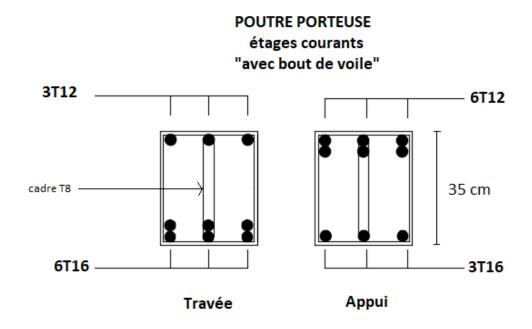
ferraillage des poutres porteuse Etage Courant avec bout de voile.
